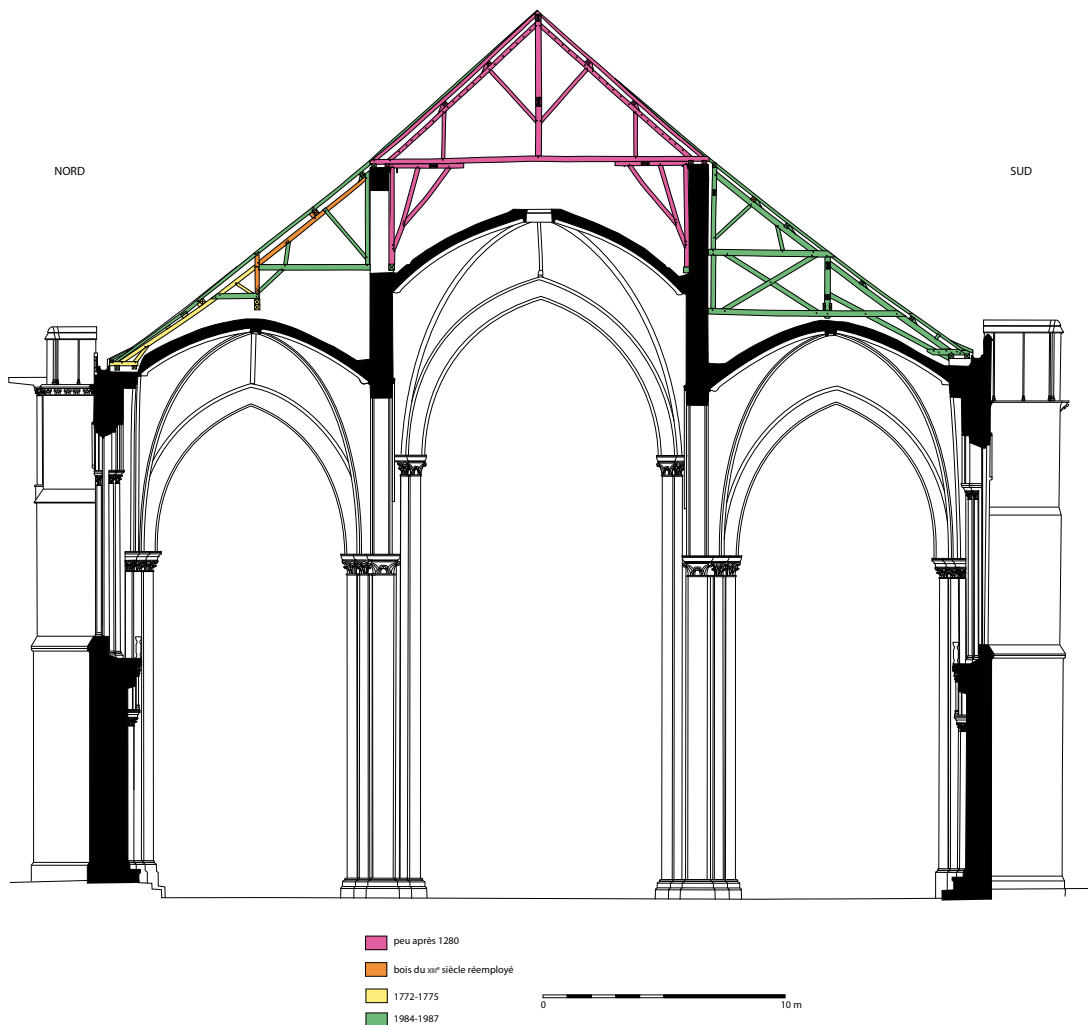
Coupe transversale de la nef au droit de F6, face ouest (relevé et DAO : F. E.).
